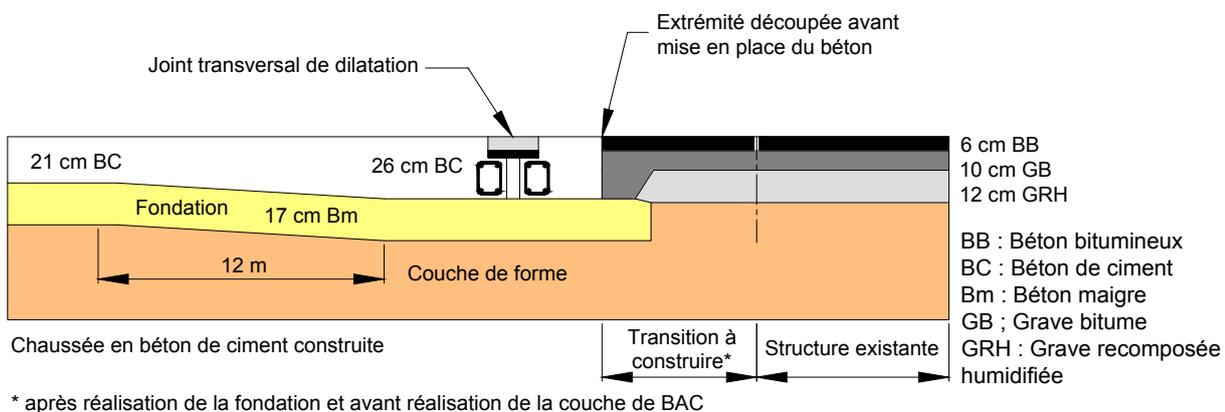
Chaussée en béton armé continu se terminant contre une structure en enrobés neuve
